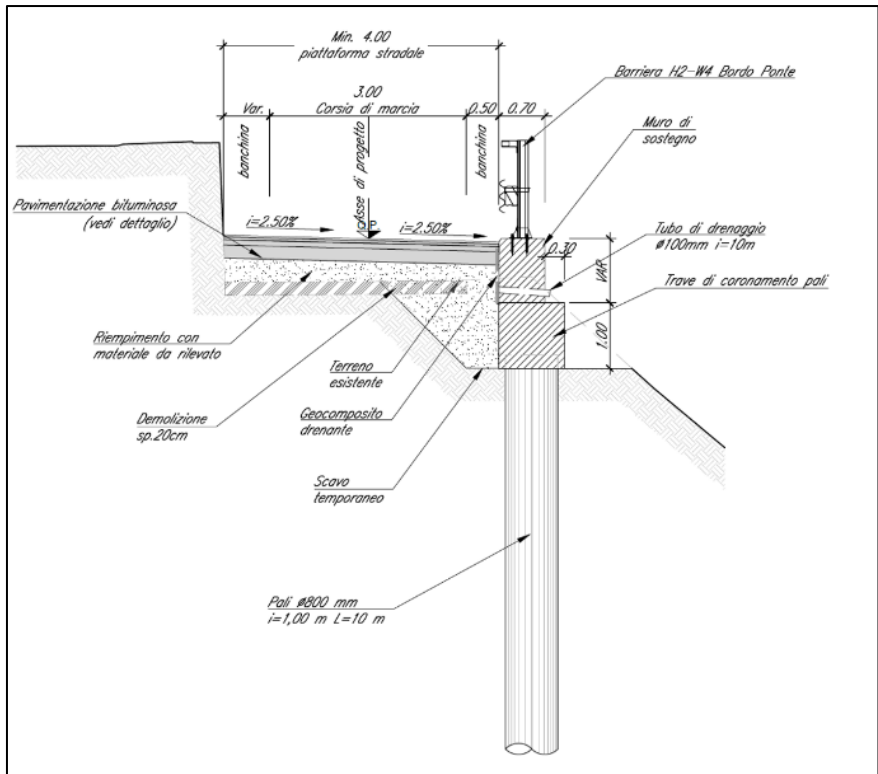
Sezione tipo NV14-Allargamento 1 (Opera-Muro di sostegno 2)
